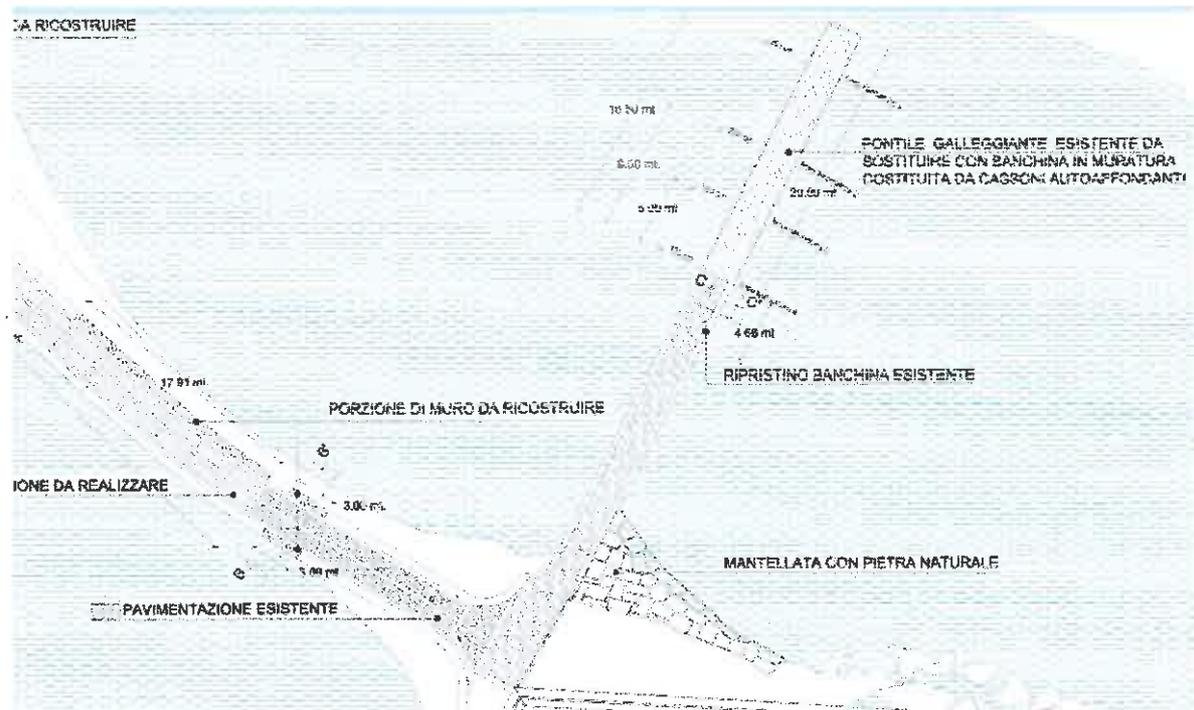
Planimetria di progetto relativa alla sostituzione del pontile galleggiante con un pontile fisso e ripristino della mantellata.
